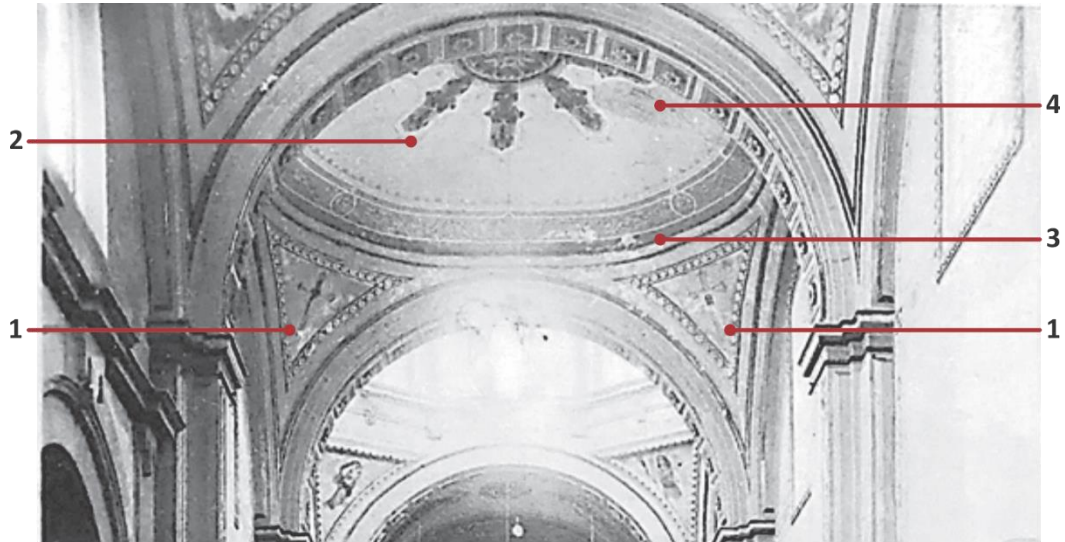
Vista interior de la Parroquia de la Santa Veracruz, 1928.
